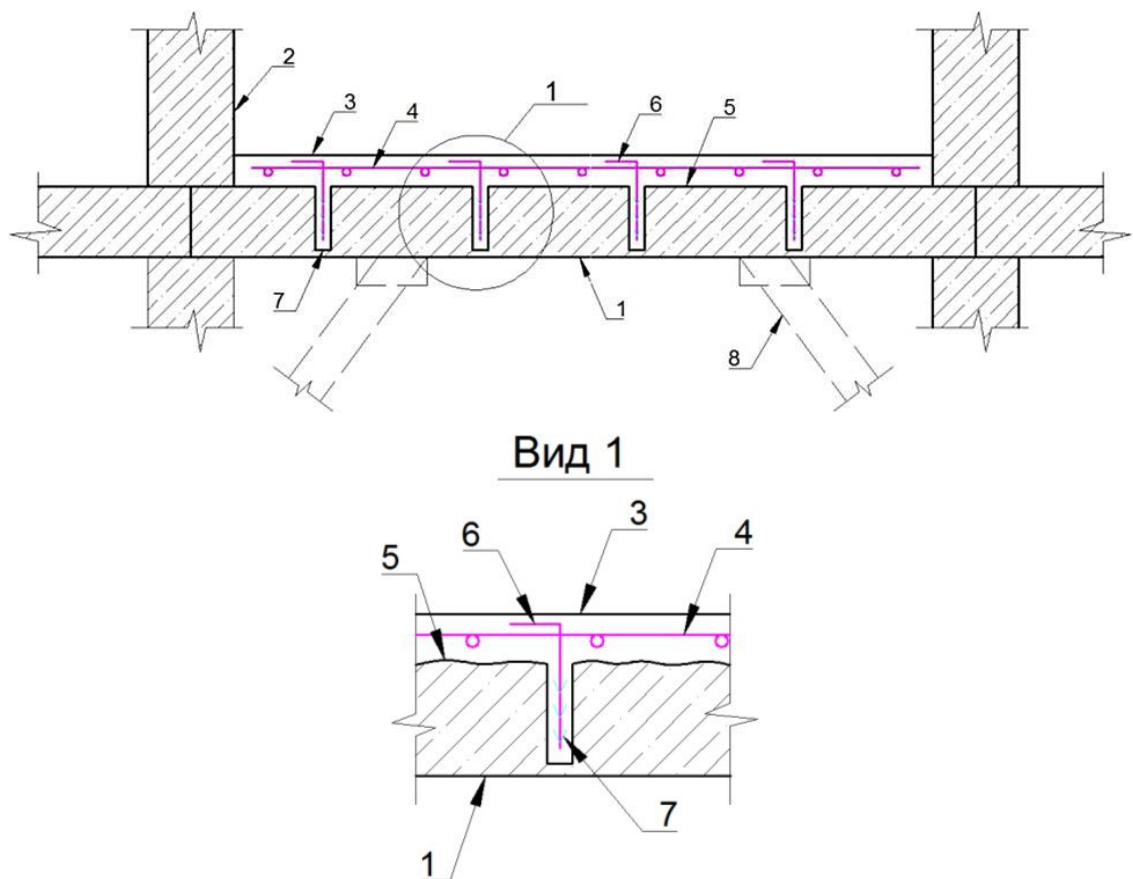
Збільшення несучої здатності плити перекриття за рахунок нарощування зверху: 1 – плита перекриття, яка підлягає підсиленню; 2 – бетонні стіни; 3 – додавання монолітного бетону зверху; 4 – додаткова арматурна сітка; 5 – площа плити, яка підготовлена до бетонування; 6 – допоміжні Г-образні анкери; 7 - отвори для анкерів з кроком 1 м; 8 – технологічні підтримуючі підкоси для усунення прогину плити
